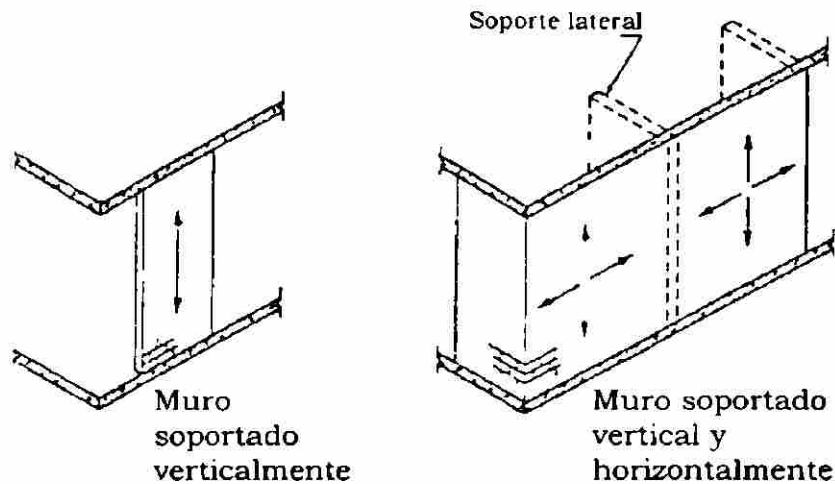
Condiciones de apoyo en muros de mampostería.
